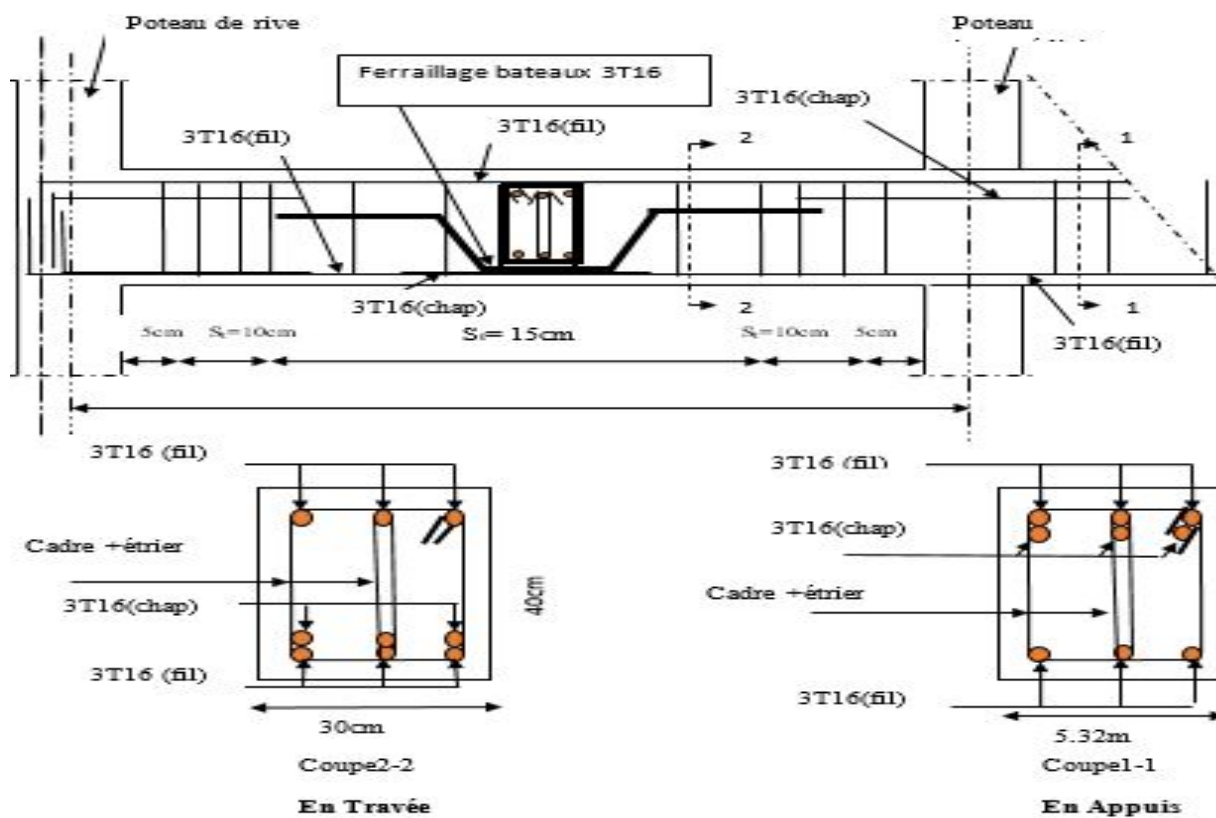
schéma de ferrailage des poutres porteuses B2
